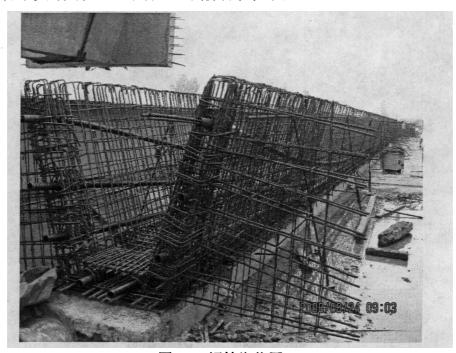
钢筋绑扎图 Fig.2-11 The picture of Steel banding
